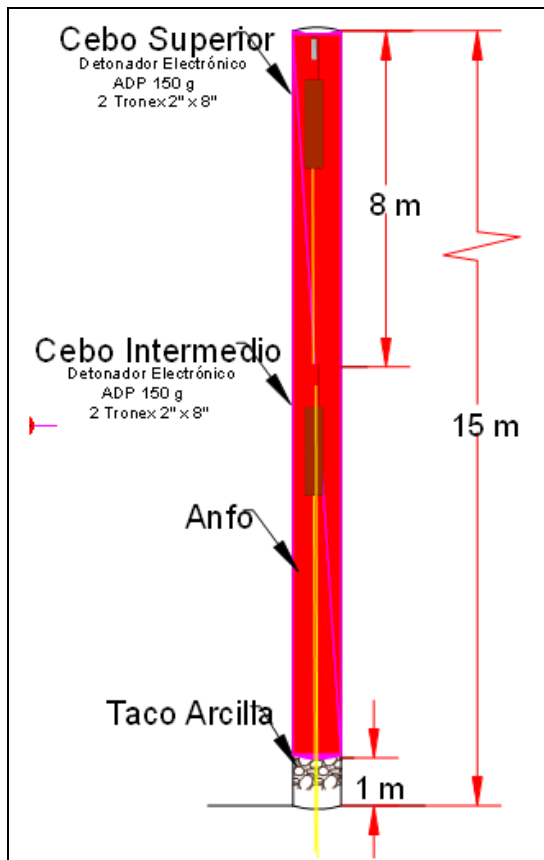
Detalle de carguío en perforaciones para Chimenea piloto.
